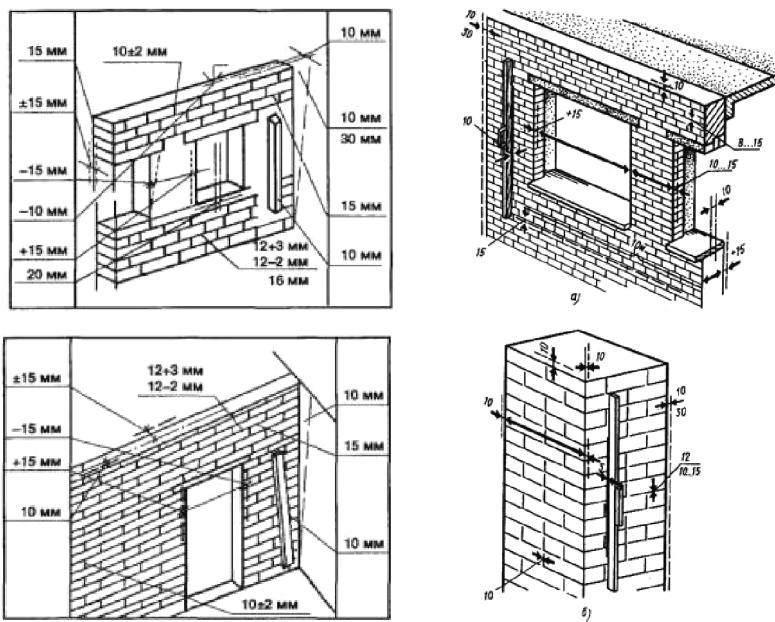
Схемы с указанием допусков в армокаменных конструкциях
